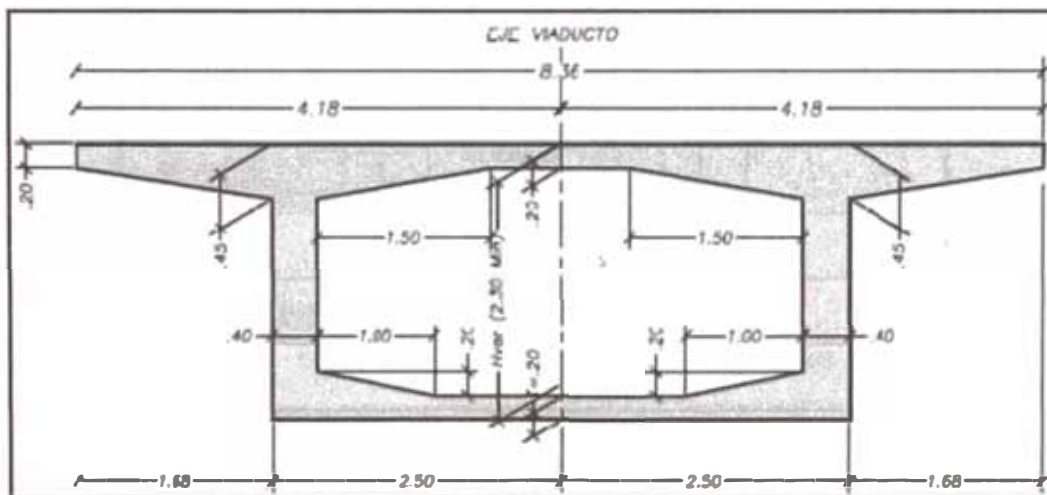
Sección transversal del Tablero sobre Pilar S49
